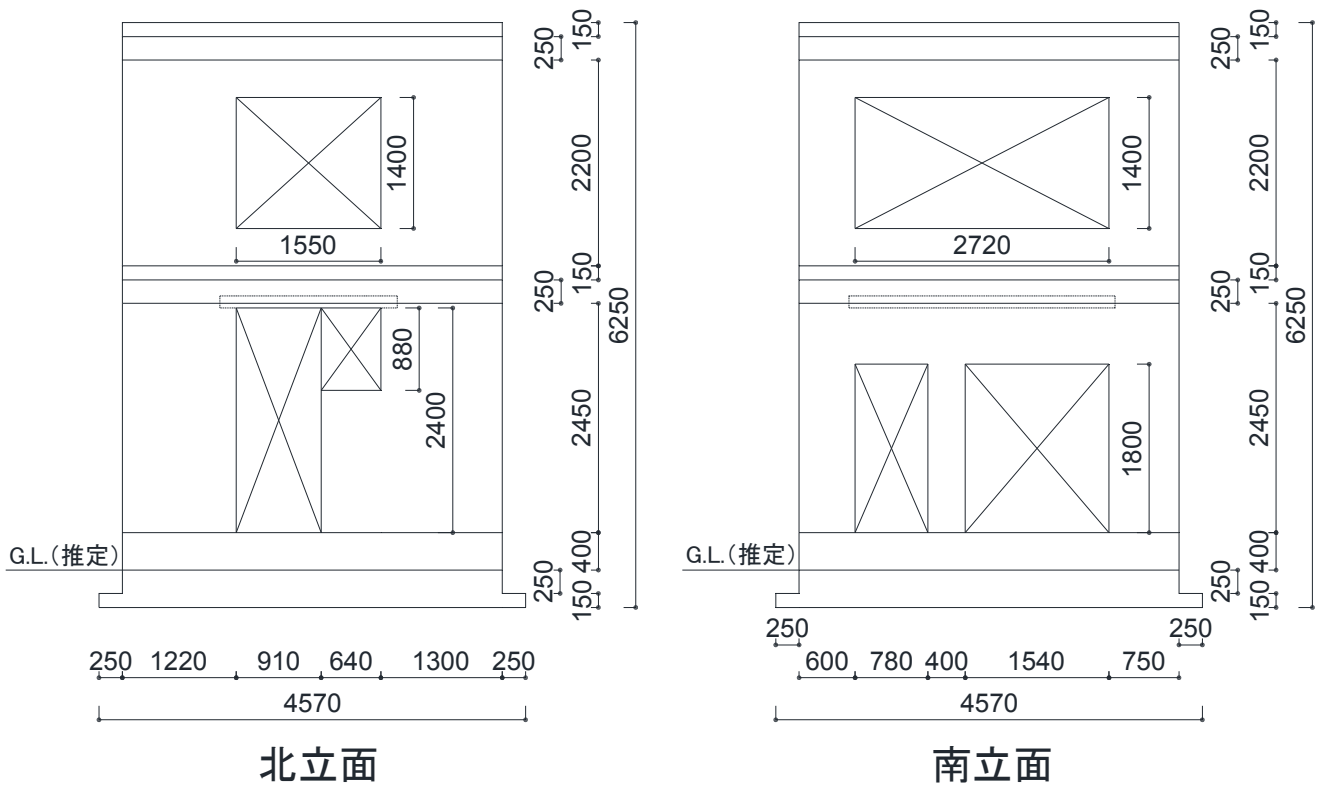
漁民住宅 1 ユニット分立面図 (単位: mm)
